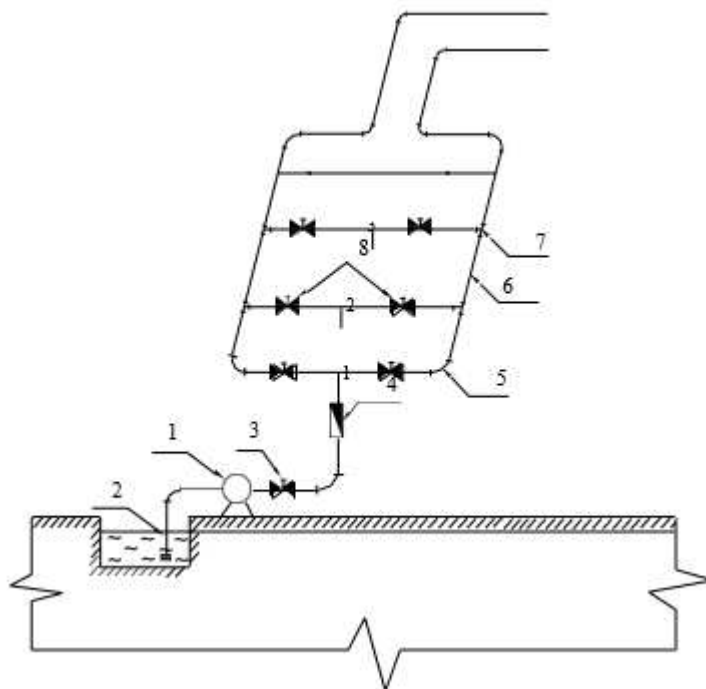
Гидравлическая схема расположения оборудования и трубопроводов в насосной станции.
